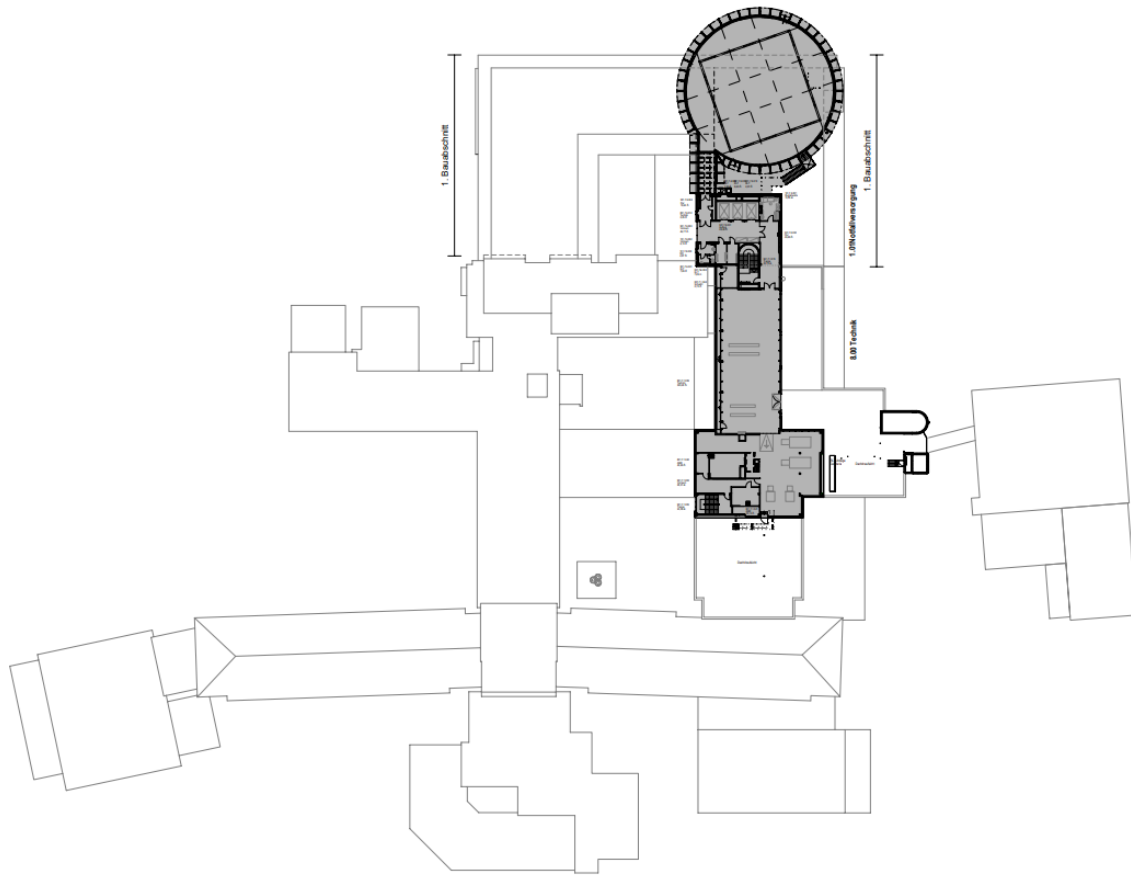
Grundriss 7. Obergeschoss mit Brandschutzmängeln (grau)
